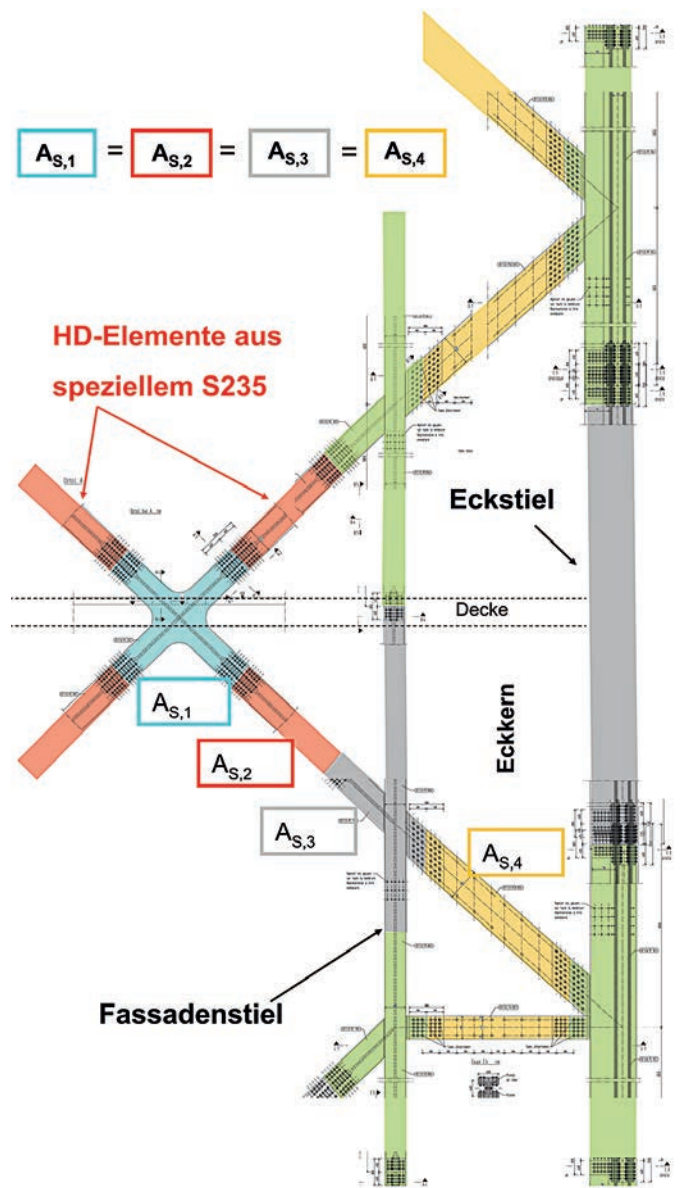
Typische Ansicht eines Stahlverbandes einschließlich der einbetonierten Teile
